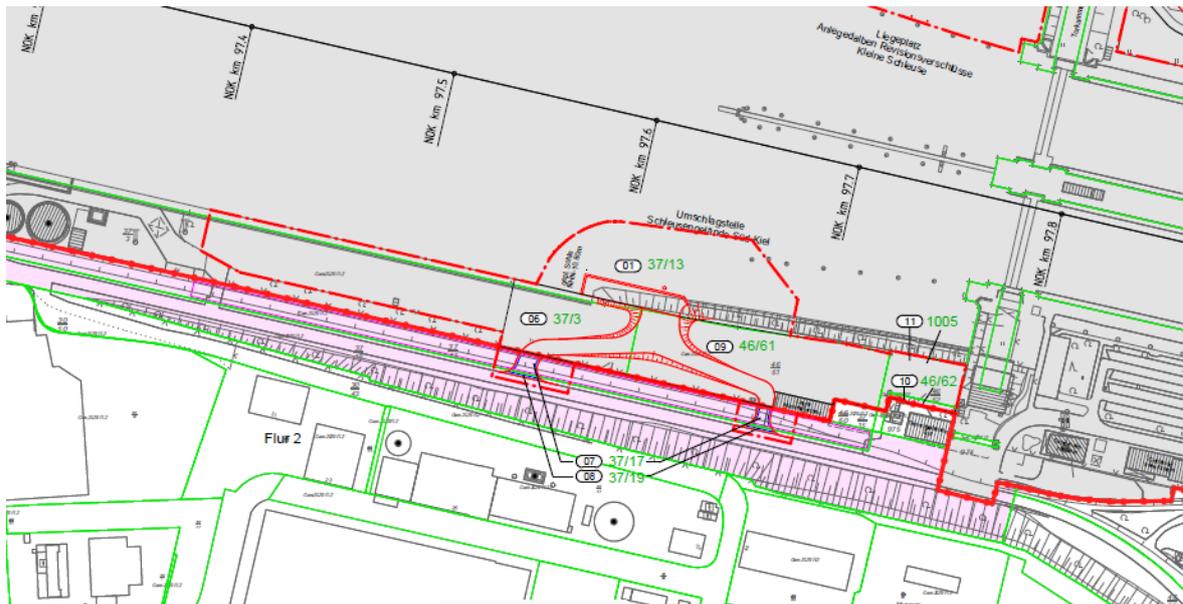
Auszug aus dem Grunderwerbsplan (Planunterlage 1.4.2)
